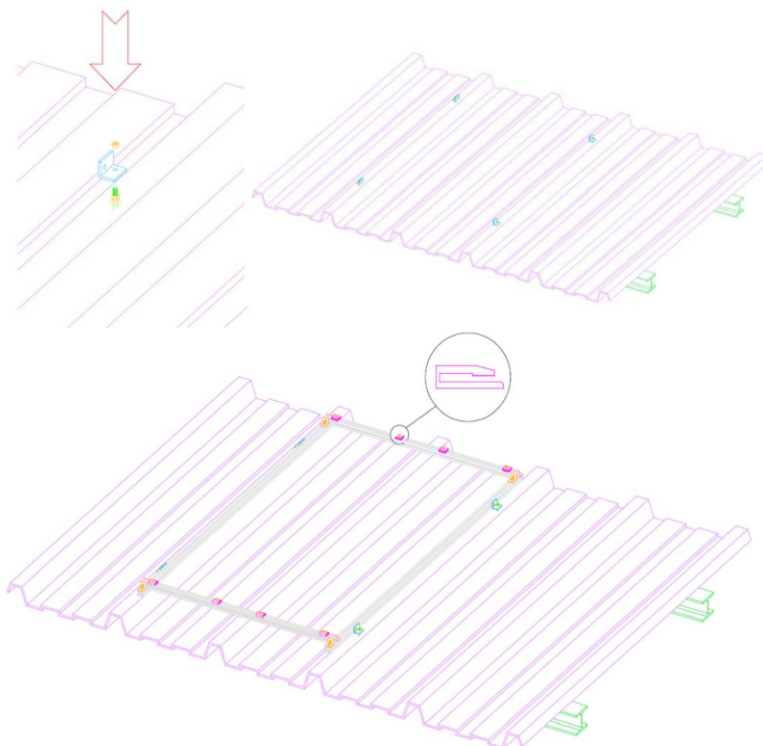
Support aluminium : mise en œuvre sur toiture plaque nervurée (suite)
